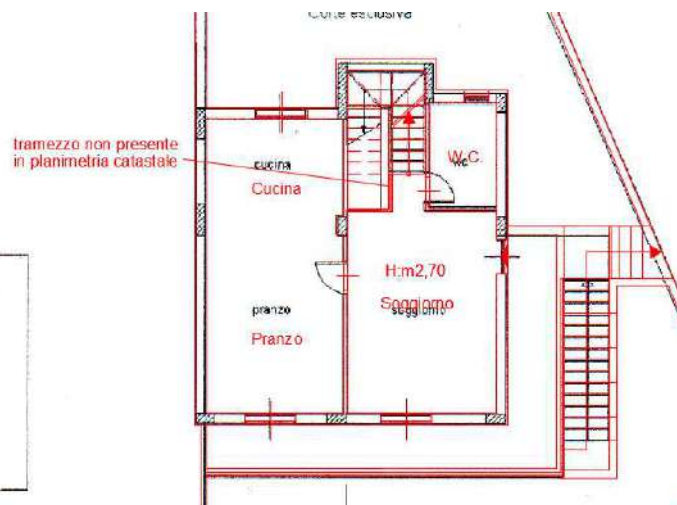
Sovrapposizione delle planimetrie di rilievo con la planimetria catastale relativa al piano terra
